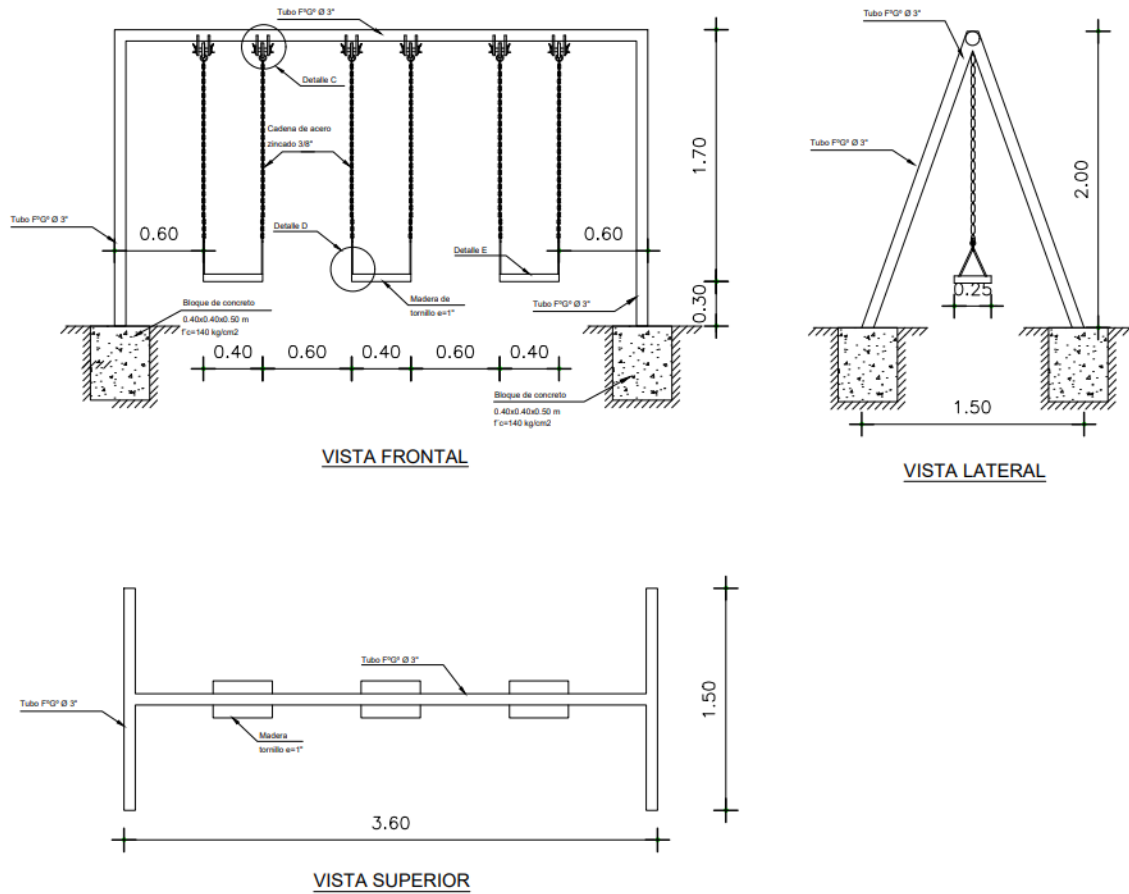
Detalle constructivo de un columpio, vista frontal, vista lateral y vista superior.
